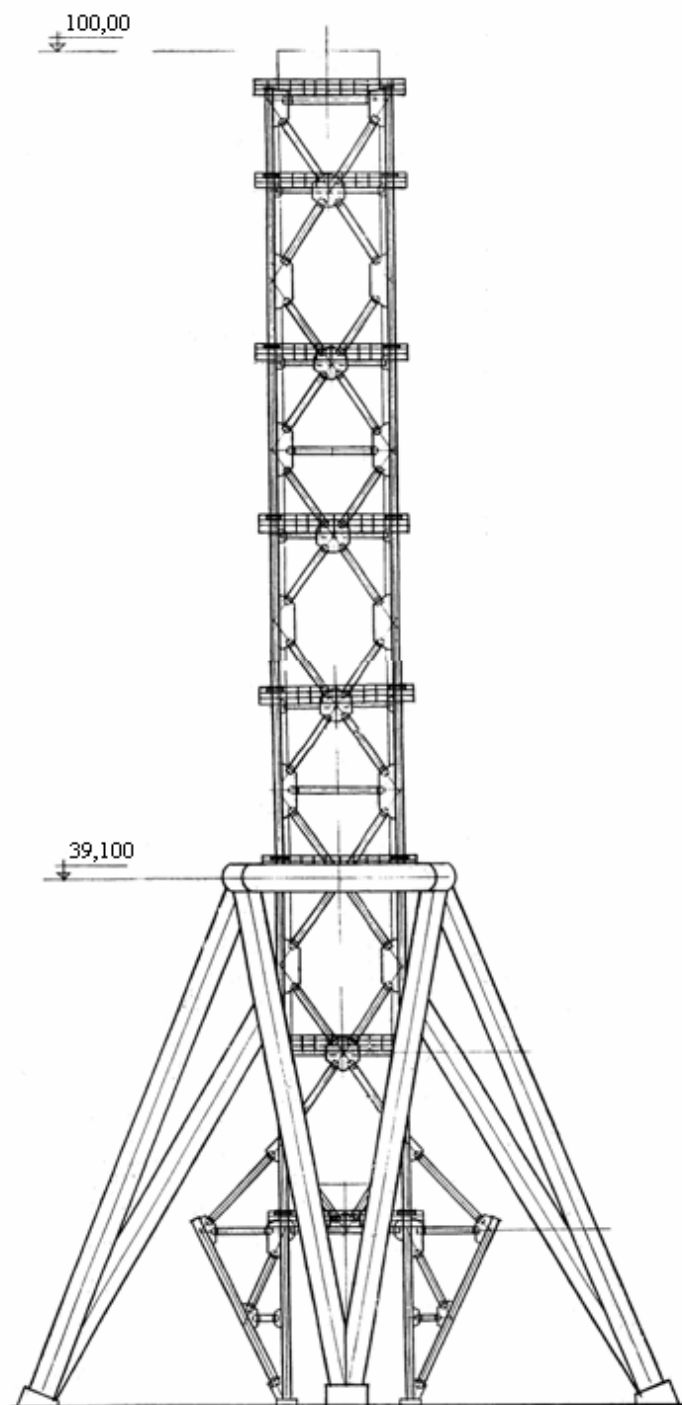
Конструктивная схема дымовой трубы с охватывающей базой
